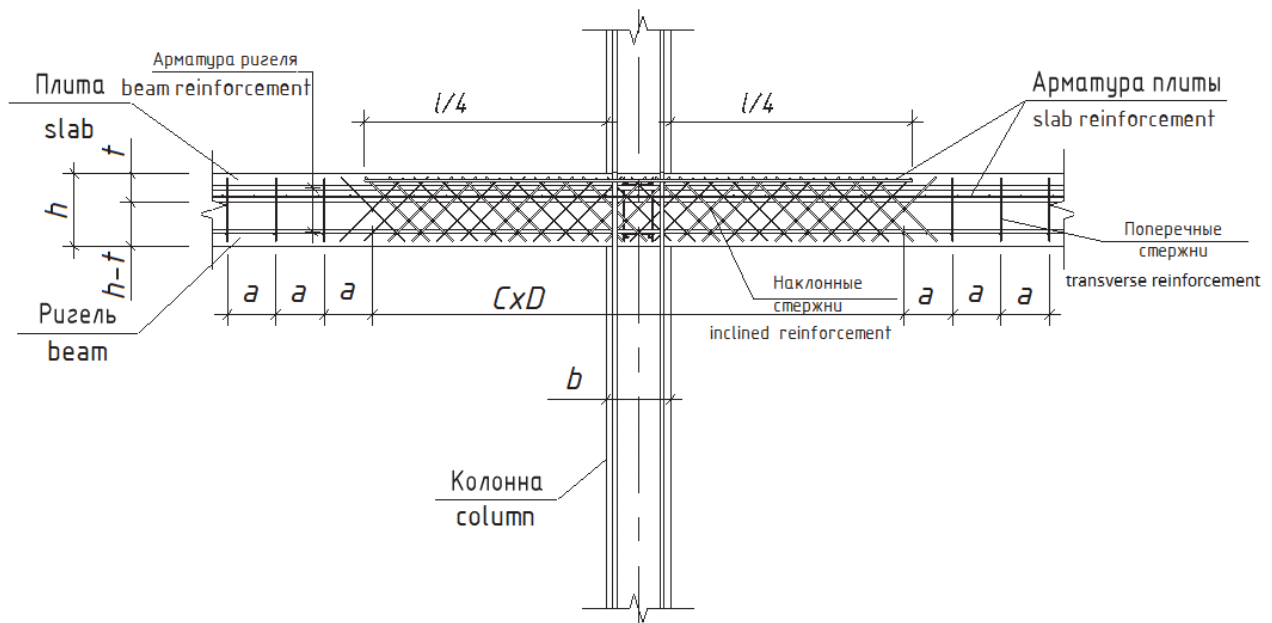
Схема армирования приопорной зоны ригеля двухсторонними перекрестными наклонными арматурными стержнями
